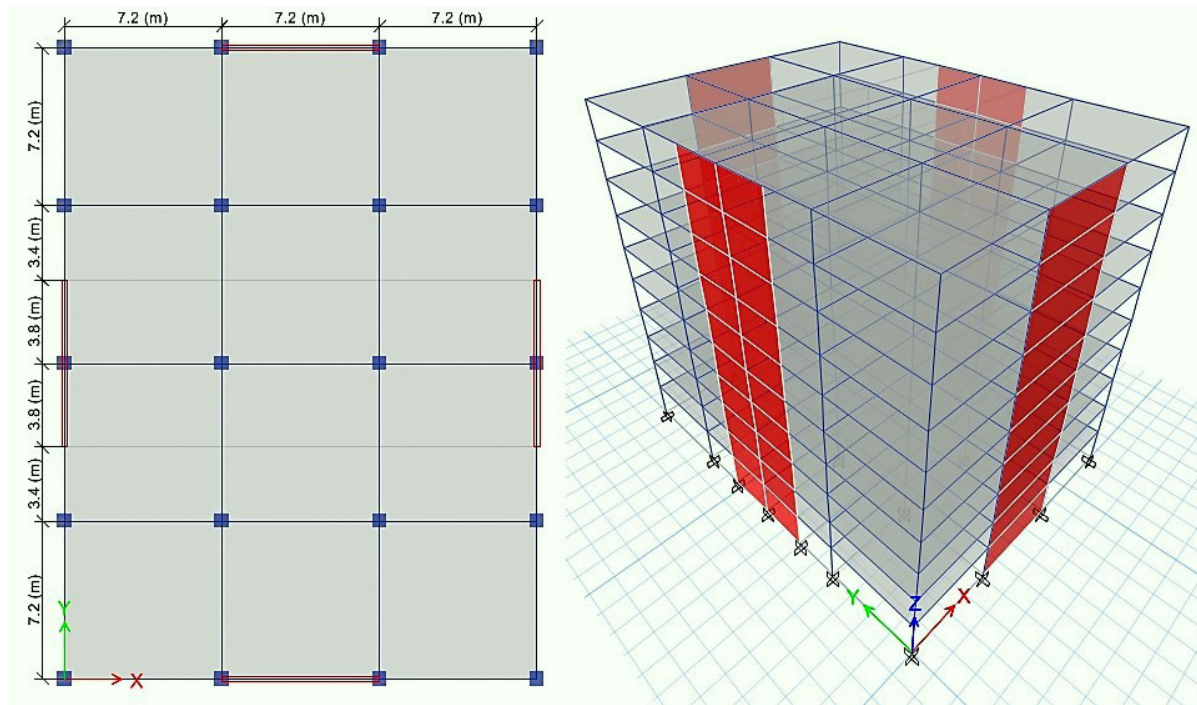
Planta y vista tridimensional de edificio. Fuente: Elaboración propia.
